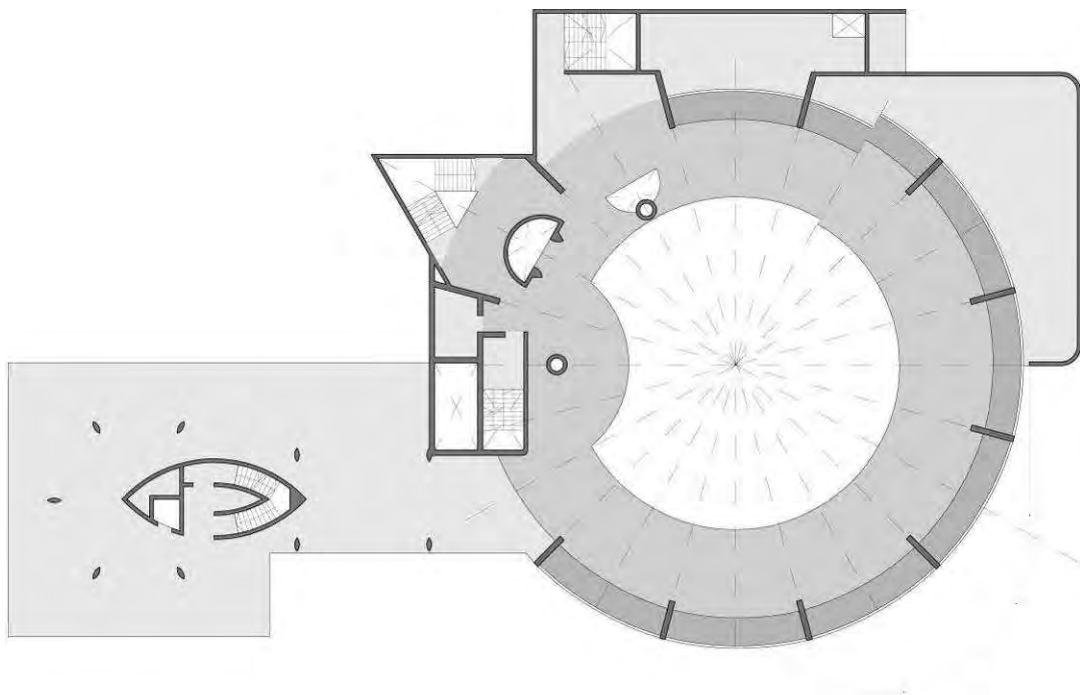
Nivel 1, Techo de la planta baja
